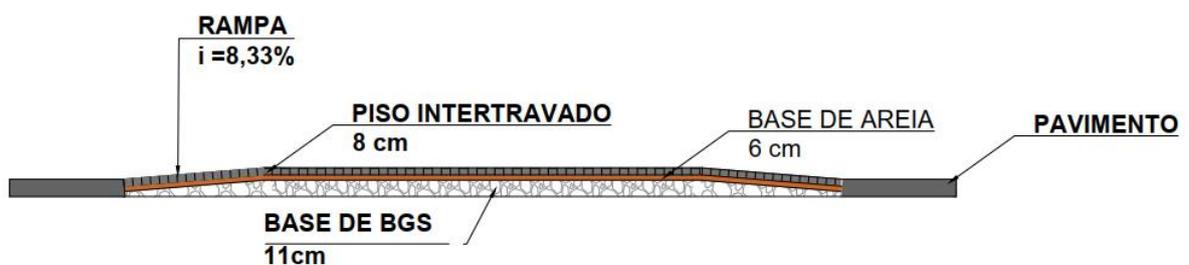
Detalhamento da faixa de pedestre elevada – corte AA
